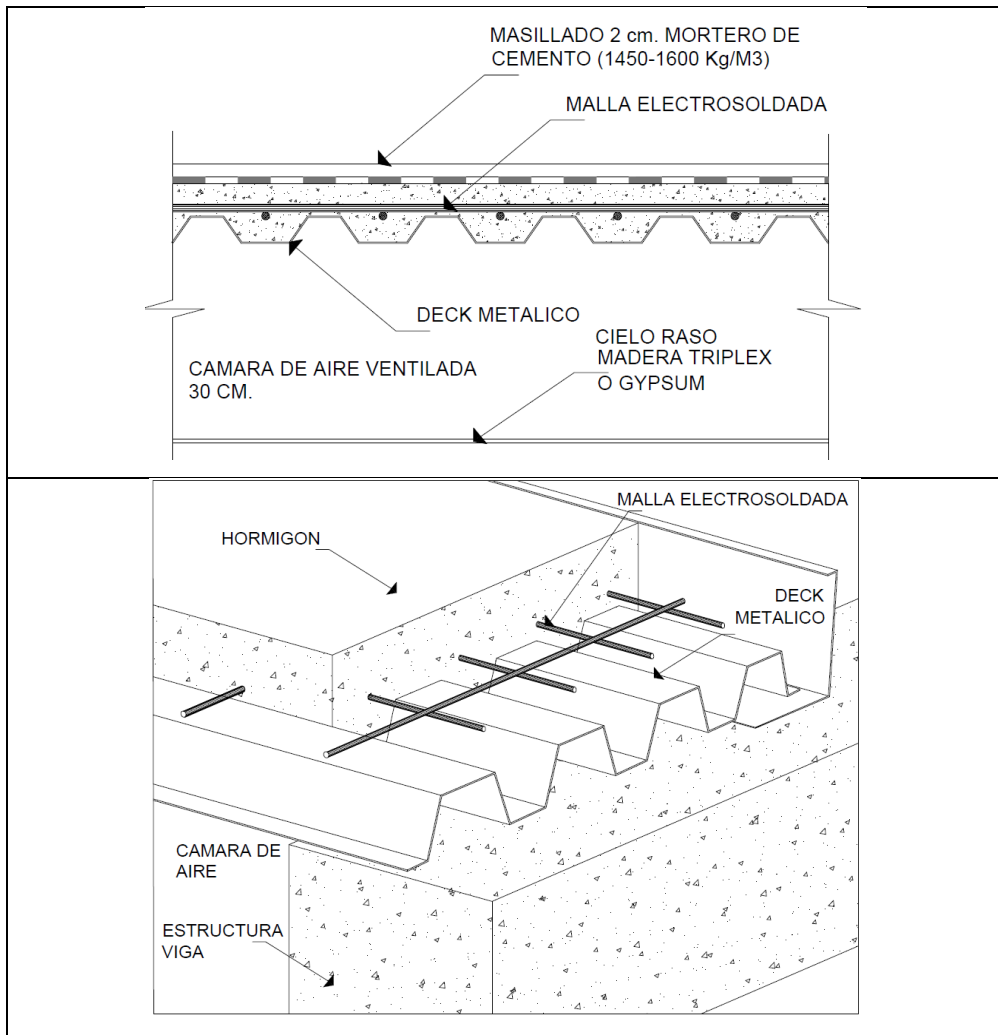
Detalle de la ejemplificación del sistema constructivo en la cubierta y el piso para la vivienda 1 y 2. Elaboración propia 2019
